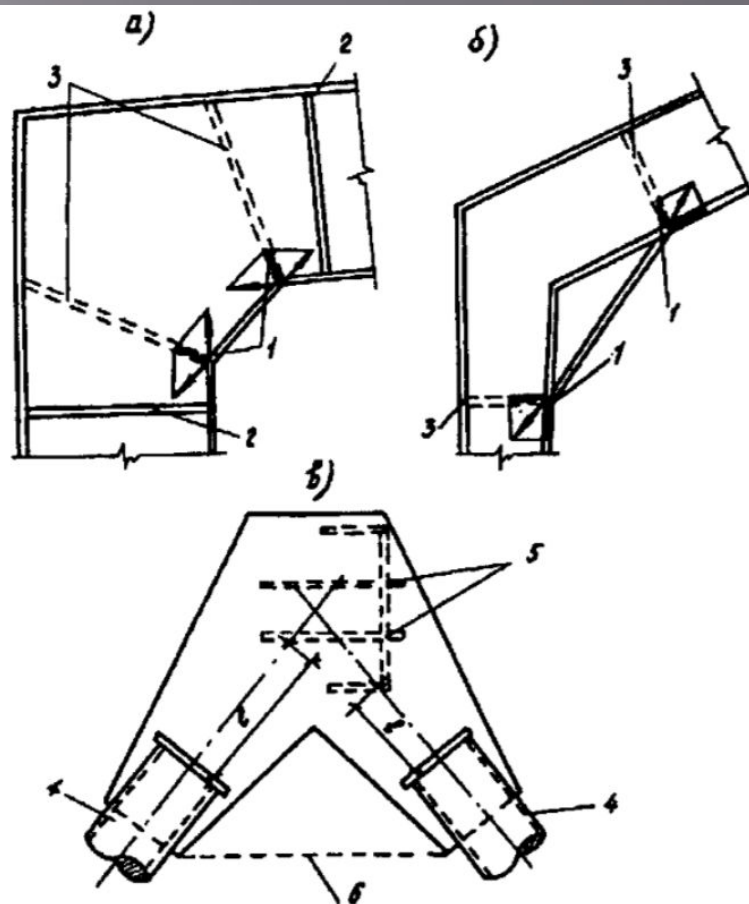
Схемы узлов примыкания элементов стальных конструкций, приведших к авариям (*а* — ригеля и колонны спортивного здания; *б* — ригеля и колонны складского здания; *в* — раскоса к горизонтальным верхним элементам структурного покрытия):
